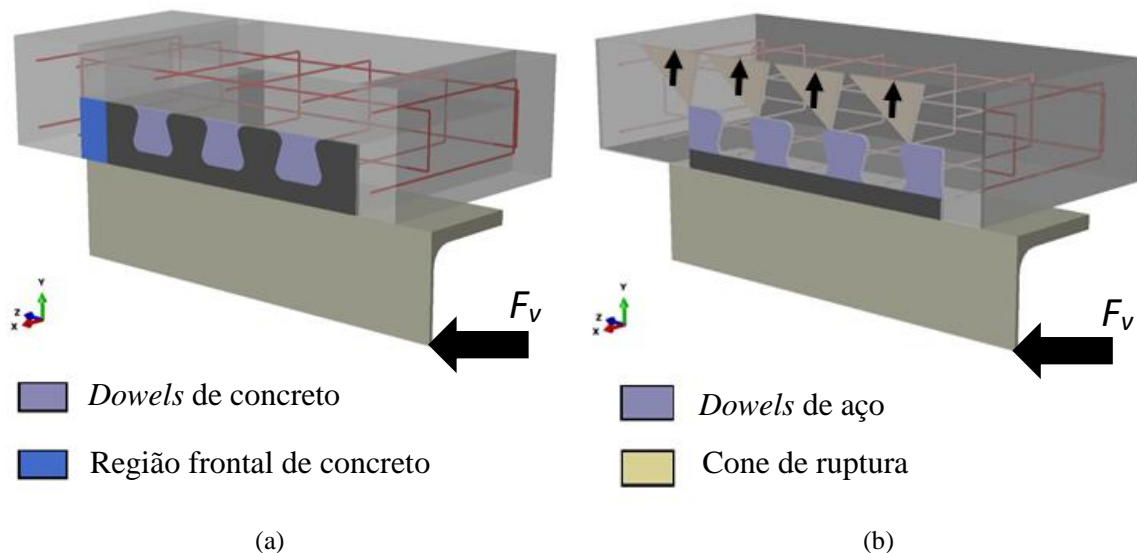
Estados-limites em vigas mistas: (a) cisalhamento do concreto; (b) *pry-out*.
